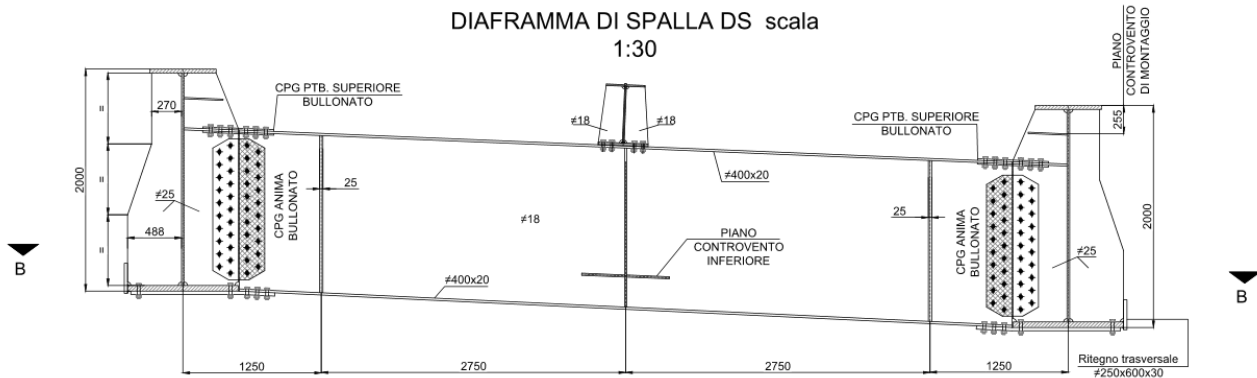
Sezione trasversale su diaframmi di spalla (pile esterne)
